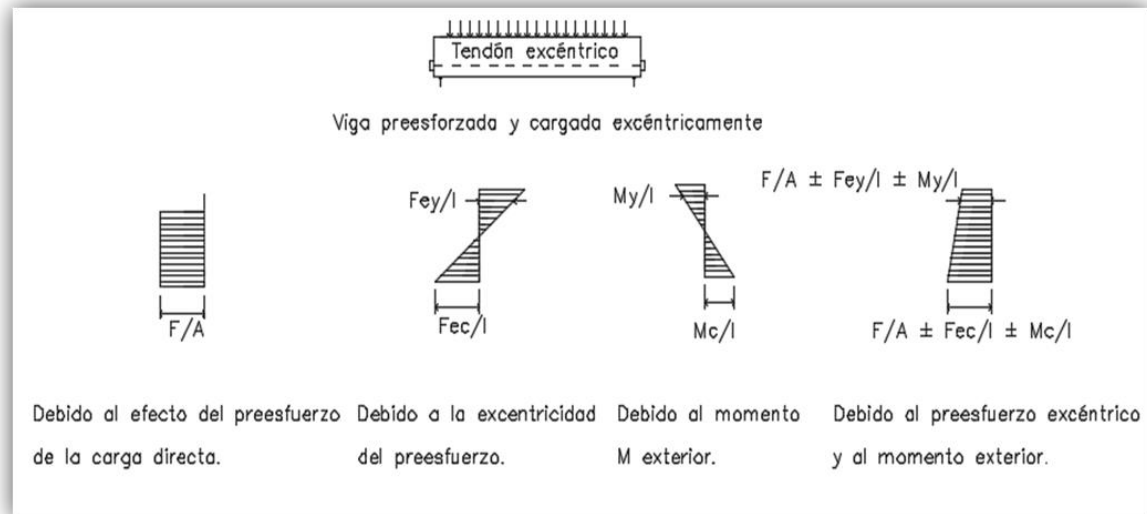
Distribución del esfuerzo a través de una sección de concreto preesforzado excéntricamente. Elaborado por la autora.
